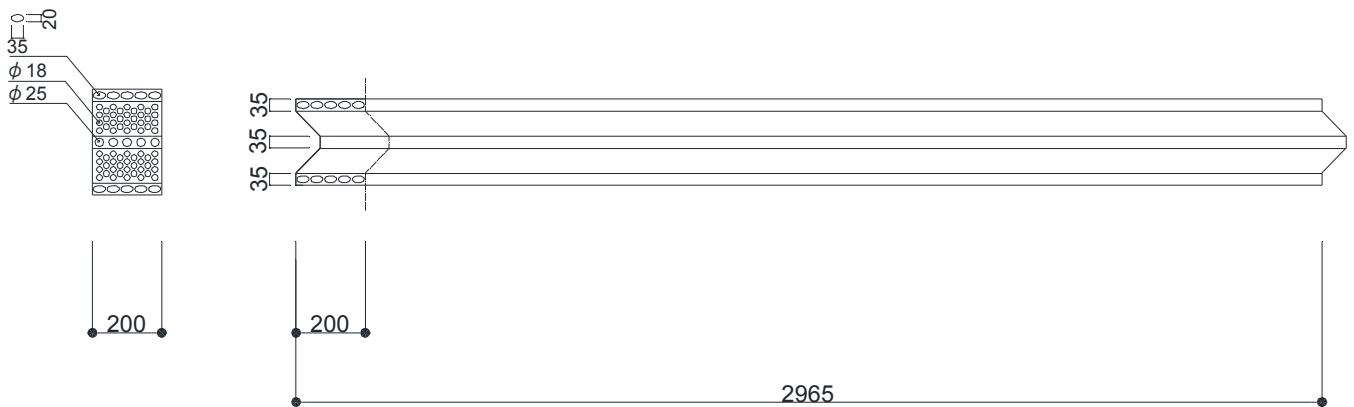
フェンスの立面図および断面図（単位：mm）
